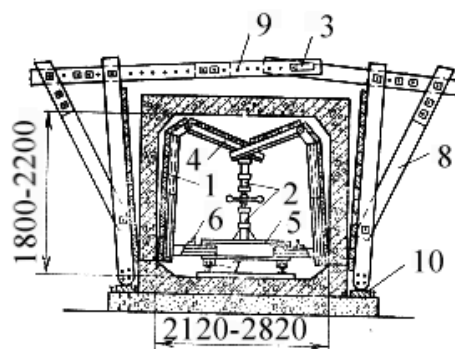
Катучая опалубка для бетонирования прямоугольного туннеля (разрез):
